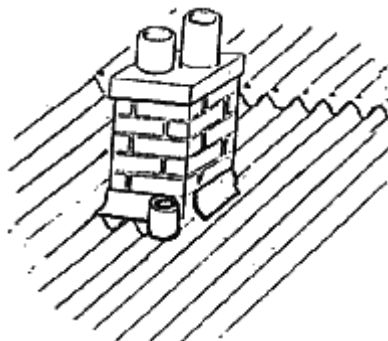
Гидроизоляция стыка кровли с печной трубой
